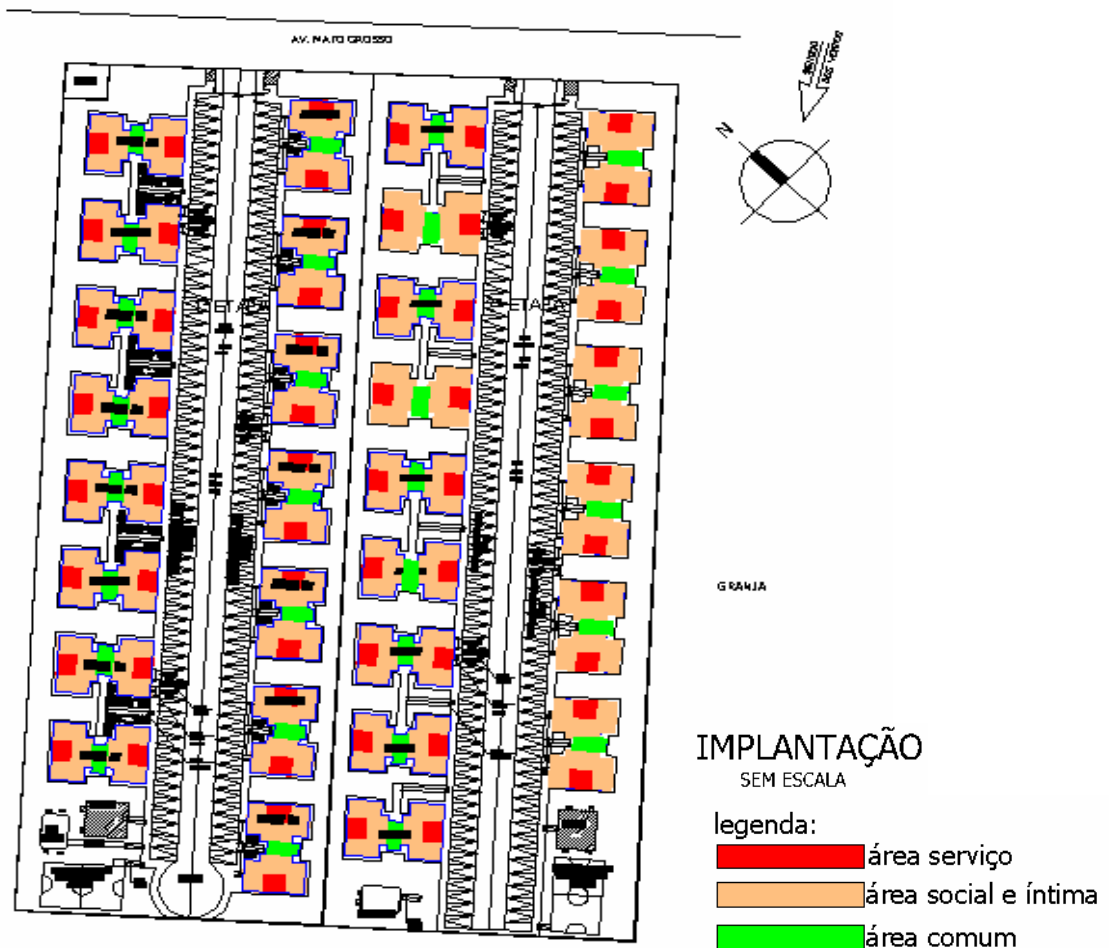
Planta de Implantação ilustrativa do Conjunto Tupy I e II
